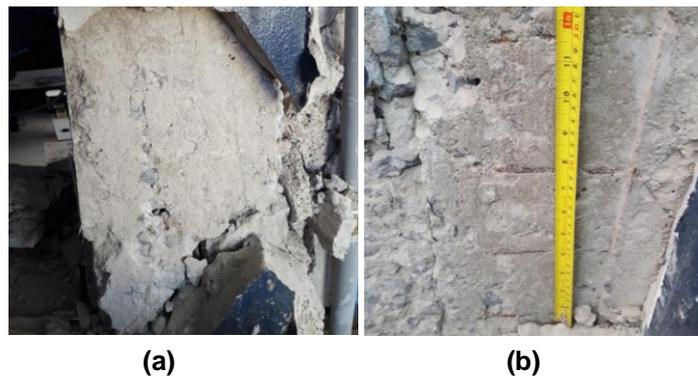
Daño en columnas, (a) Fallas en pie o cabeza de la columna, mal confinamiento de la columna, (b) Columnas con poco recubrimiento y una mala dosificación de la mezcla de hormigón.
